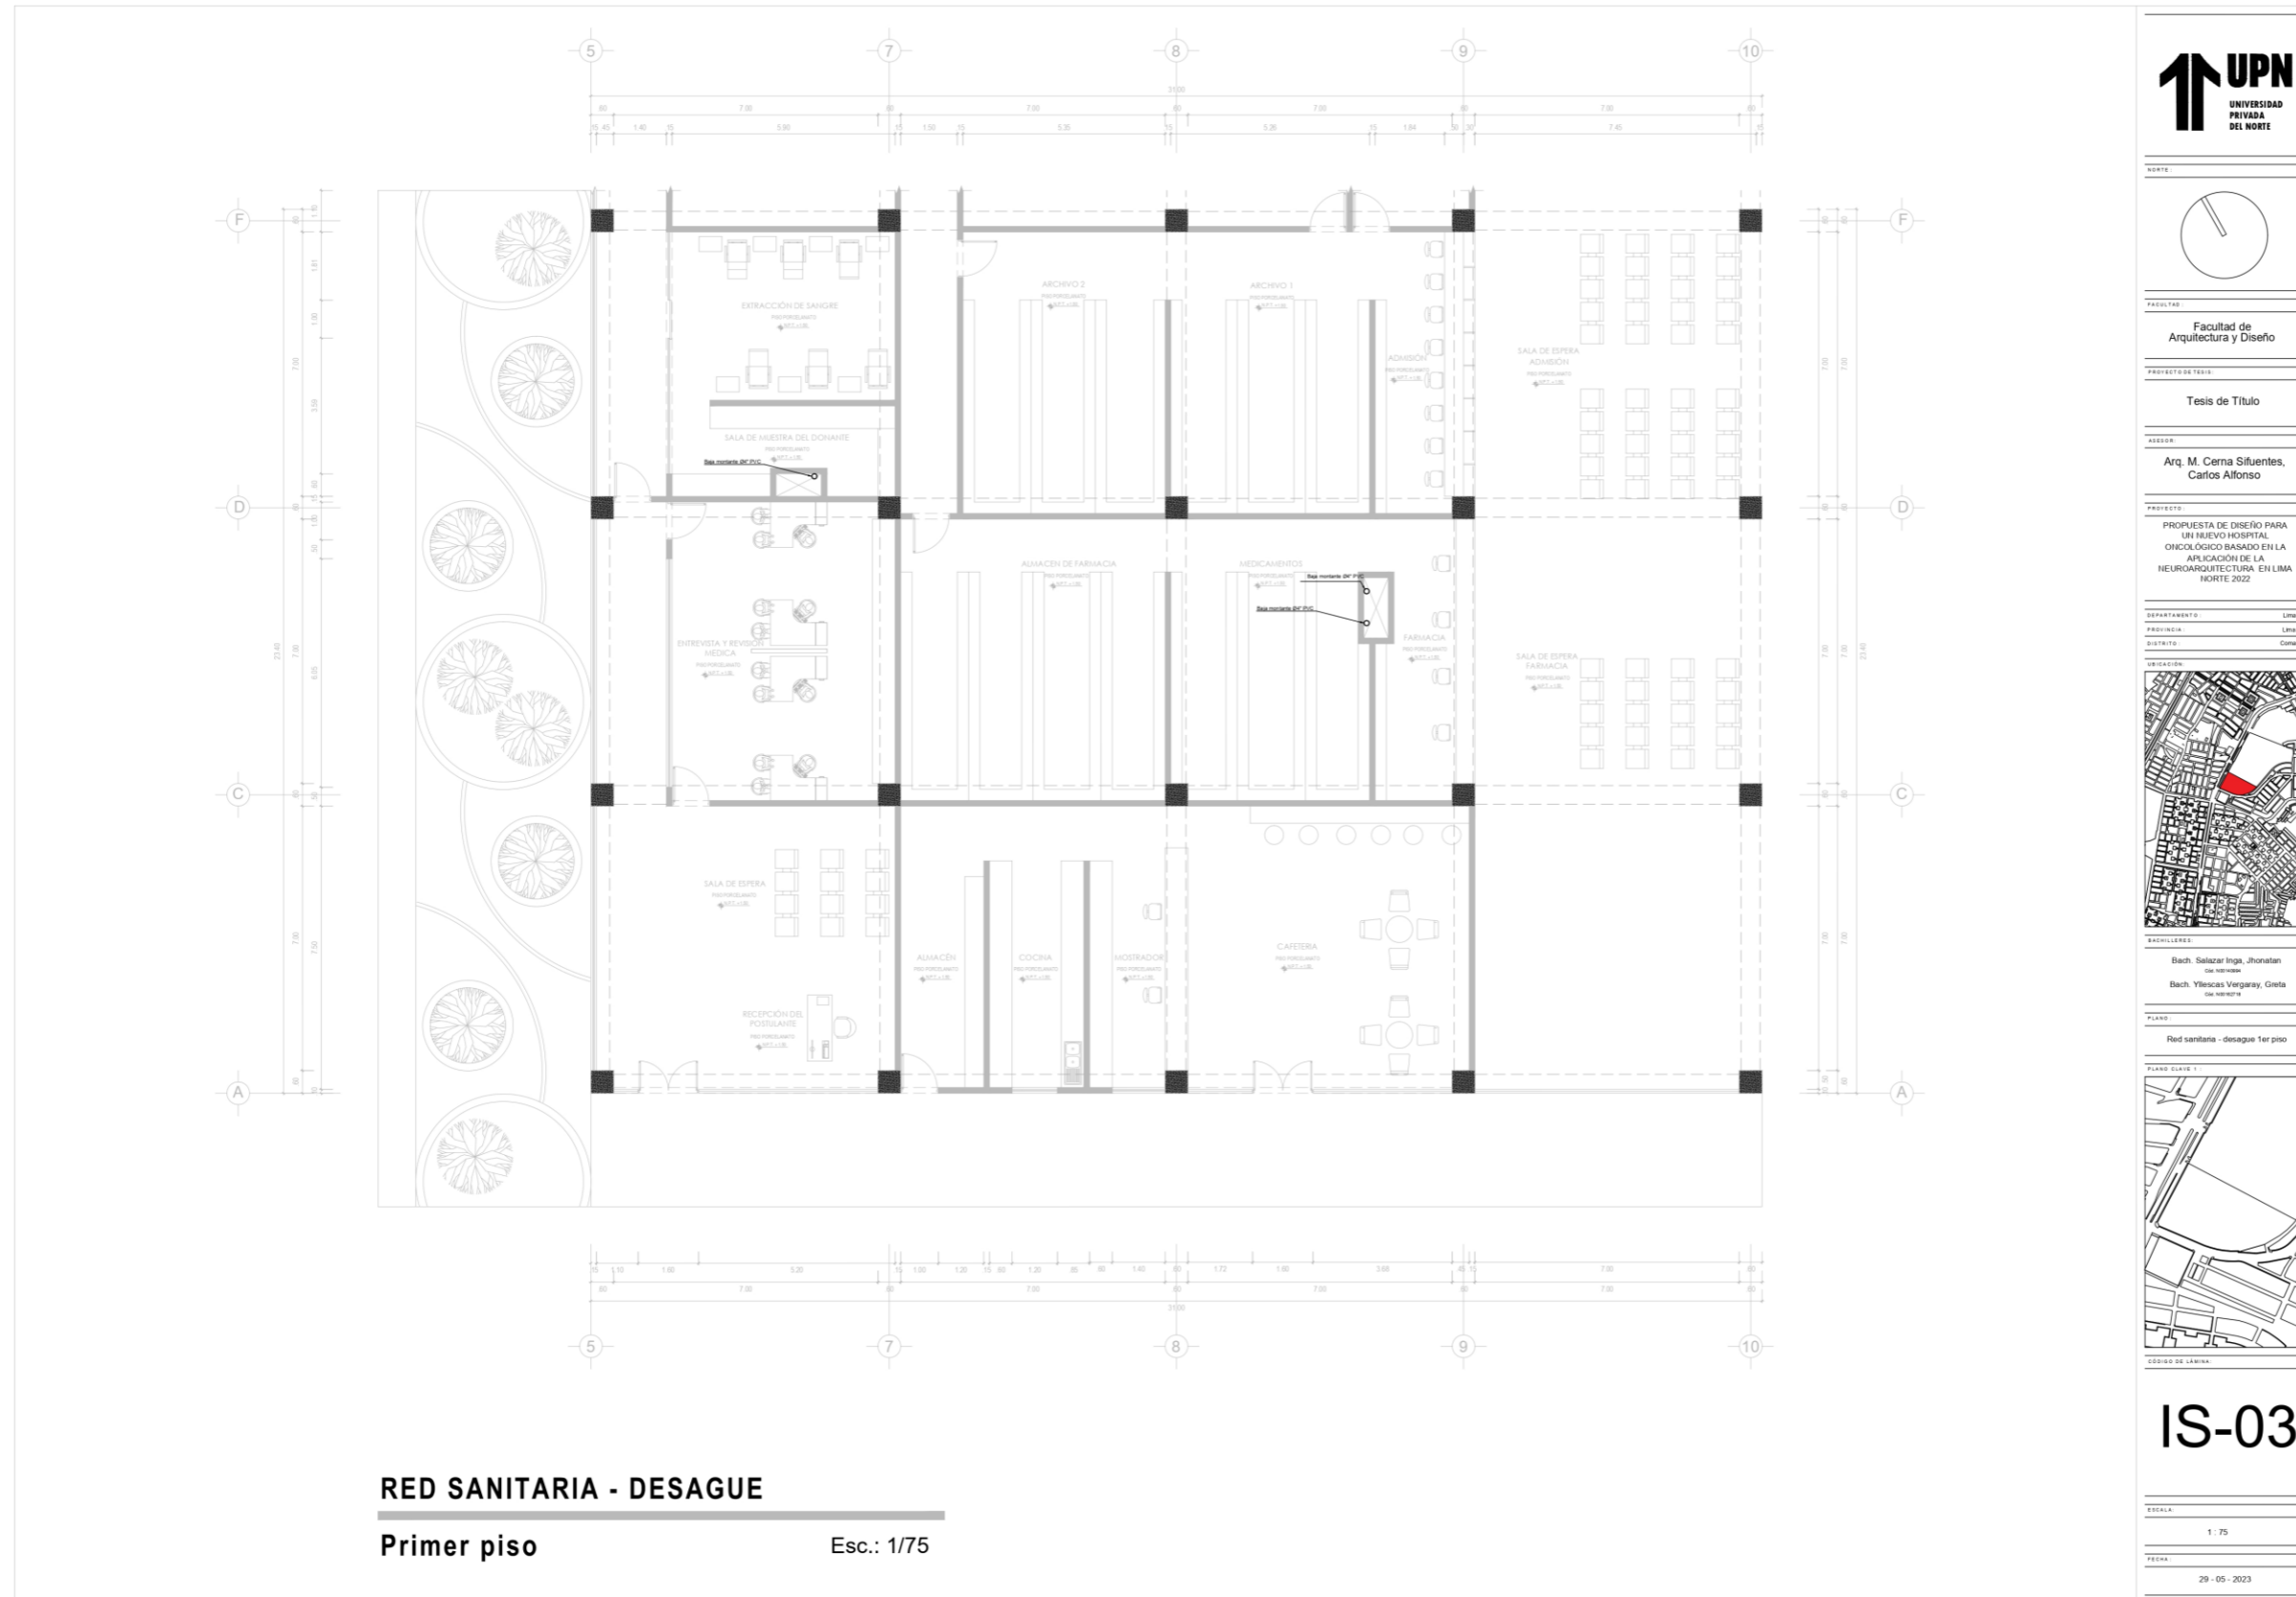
Instalaciones Sanitarias – Red de desague nivel N°1 del sector cuadrante Esc: 1/75 (Fuente: Elaboración propia de los coautores)
